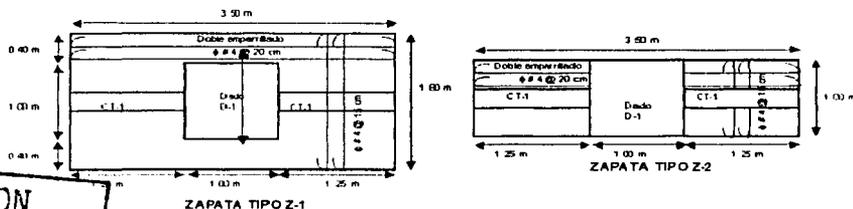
Detalle del armado de las zapatas Z-1 y Z-2
